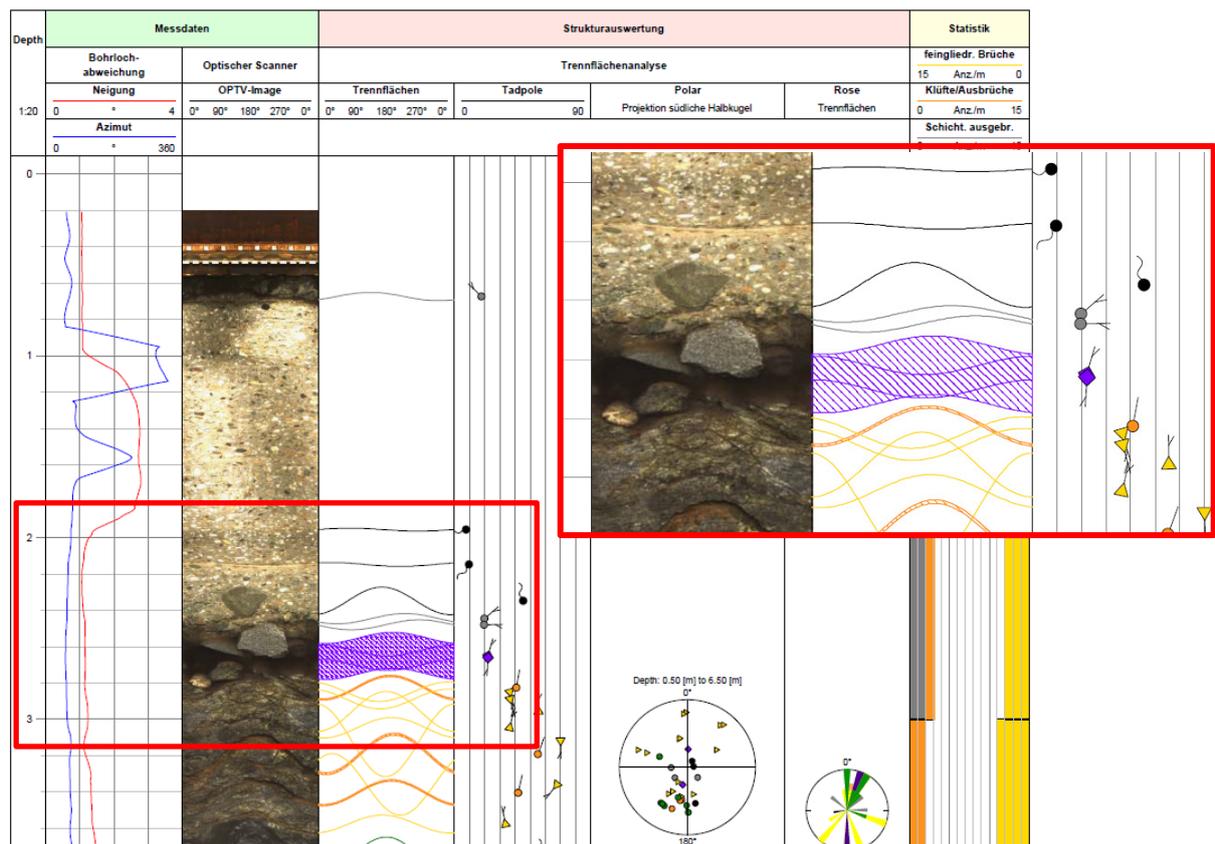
Messprotokoll eines optischen Bohrlochscanners mit Detailabschnitt Übergang Beton/Fels
